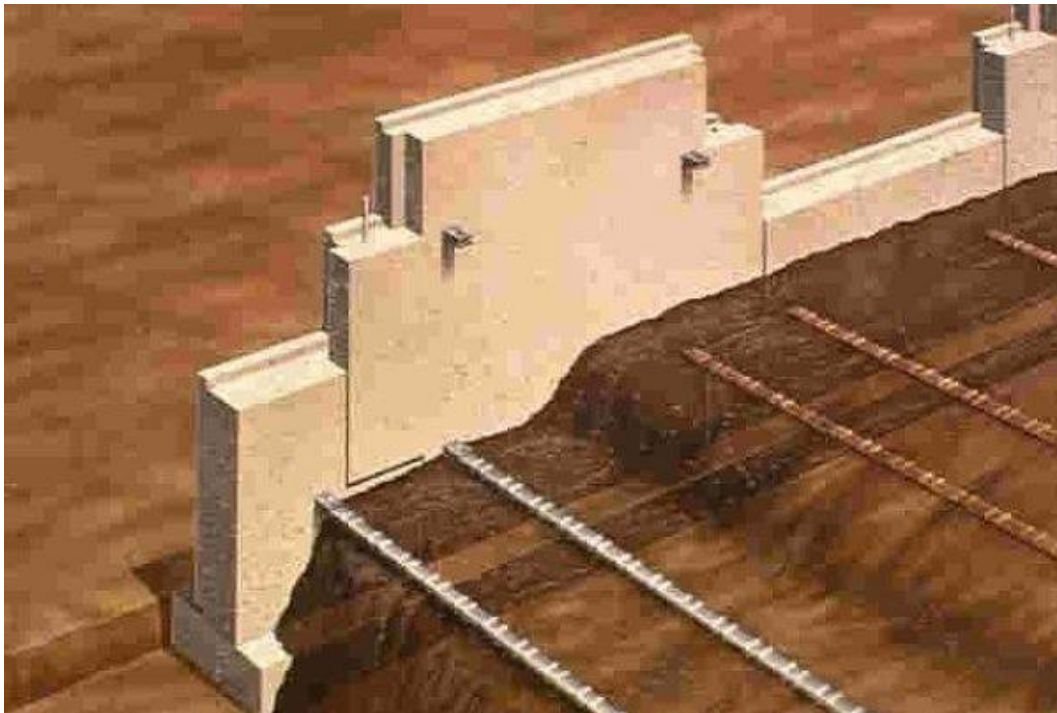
Detalhe do paramento, fixadores e armaduras
